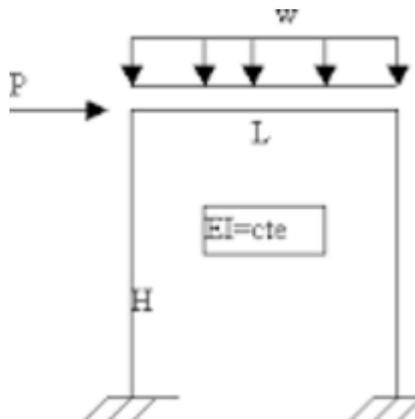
Ejemplo de las cargas de trabajo sobre un pórtico de la plataforma
